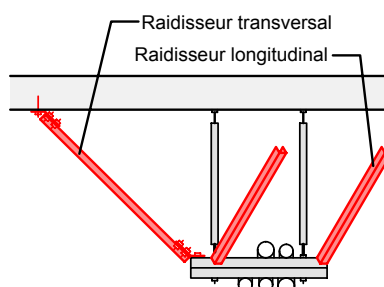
> Contreventement longitudinal et transversal de consoles
